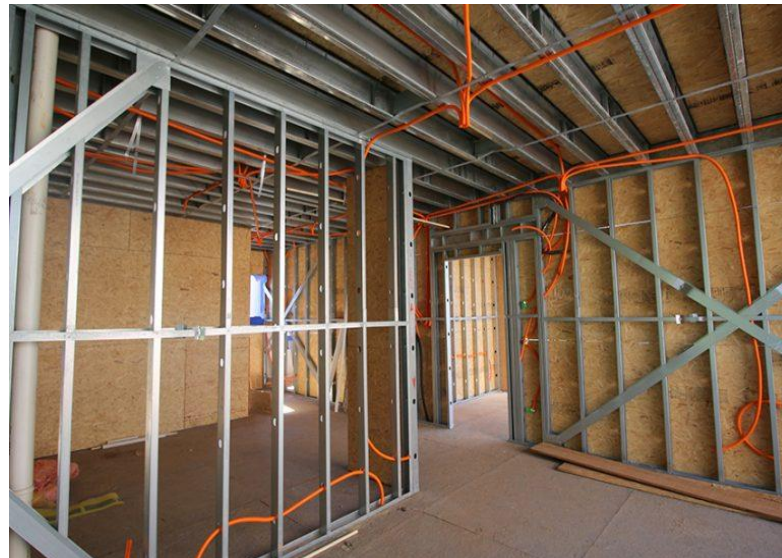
Instalação hidráulica em Steel Frame e Convencional
